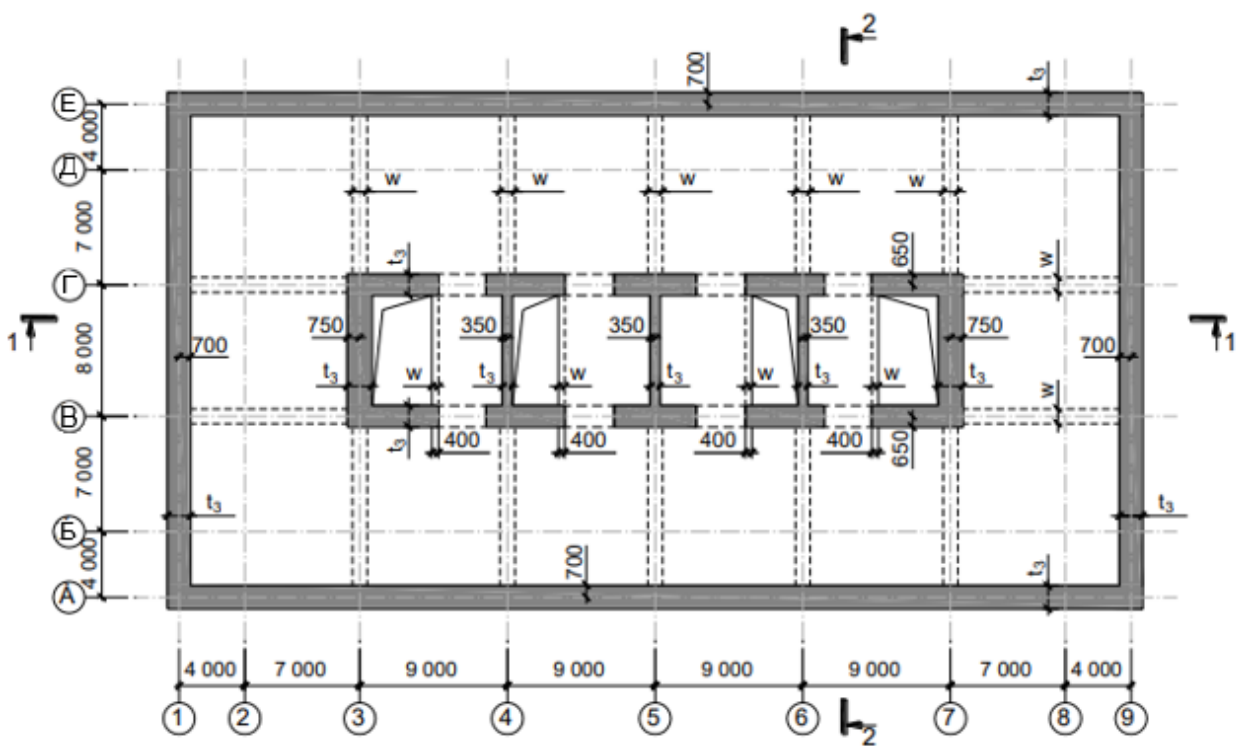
Схематический план подземного -2 и -1 этажа.
